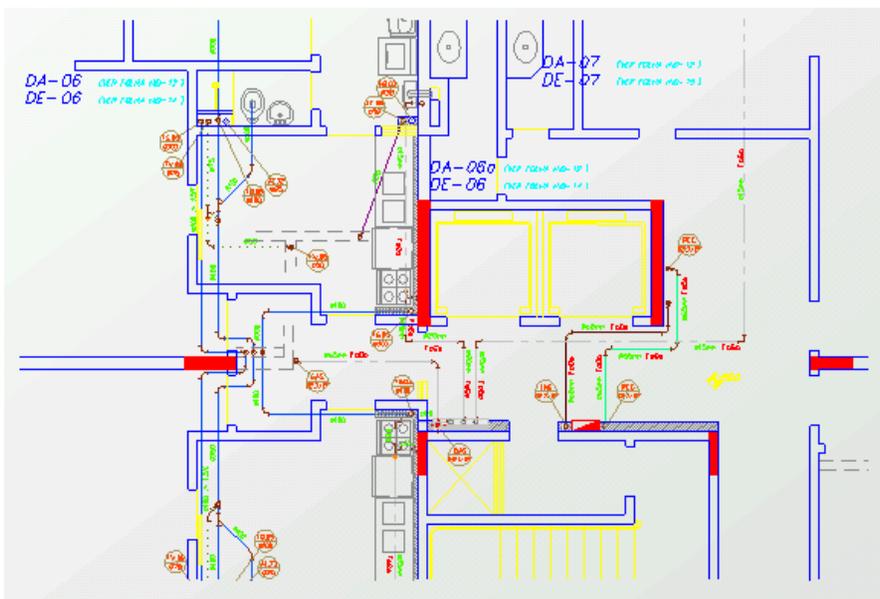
Exemplo de Planta Baixa e DESTAQUES DAS INSTALAÇÕES.
